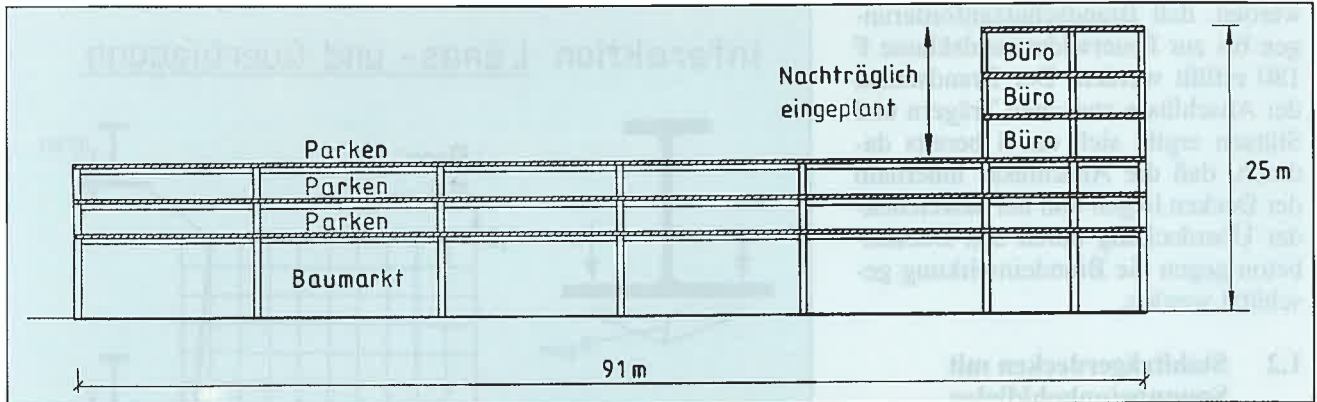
Technologie-Park Bergisch Gladbach, Haus 50/51 (Entwurf: Planungsbüro Dipl.-Ing. Architekt Zimmermann, Bergisch Gladbach): Gesamtquerschnitt mit aufgesetzten Bürogeschossen
